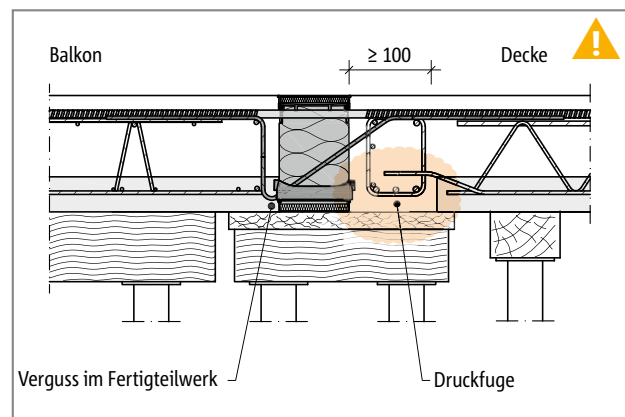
Schöck Isokorb® CXT Typ K: Indirekte Lagerung, Einbau in Verbindung mit Elementplatten (hier: $h \leq 170$ mm), Druckfuge deckenseitig
